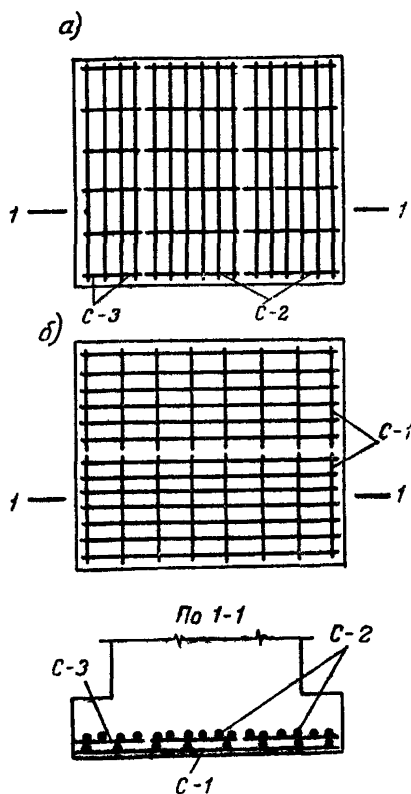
Расположение сварных сеток при армировании фундамента узкими сетками
